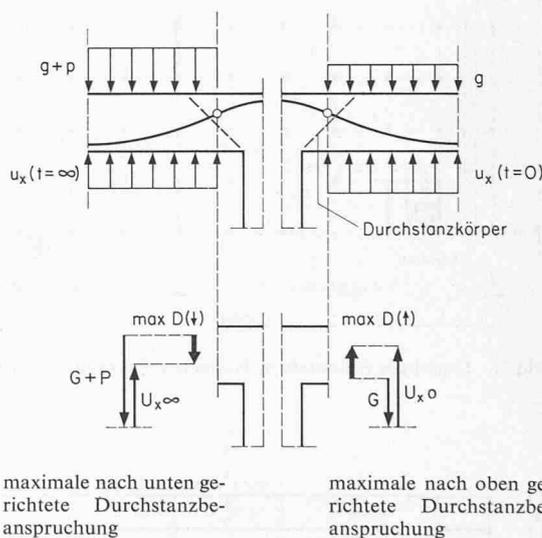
Durchstanzbeanspruchung bei Flachdecken mit Stützstreifen-Vorspannung (nur ausserhalb des Durchstanzkörpers angreifende Kräfte betrachtet)
